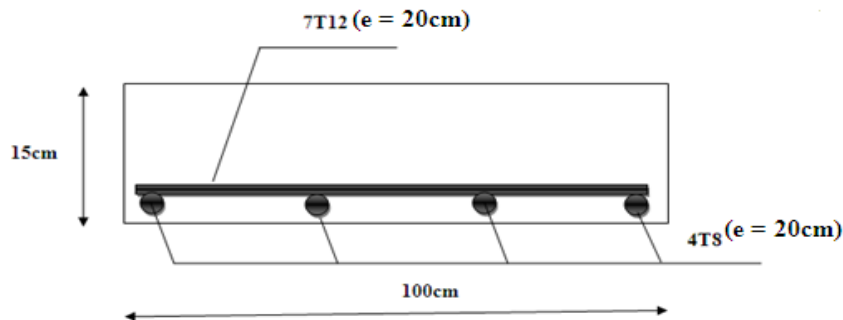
Schéma de ferrailage de l'escalier en travée.
